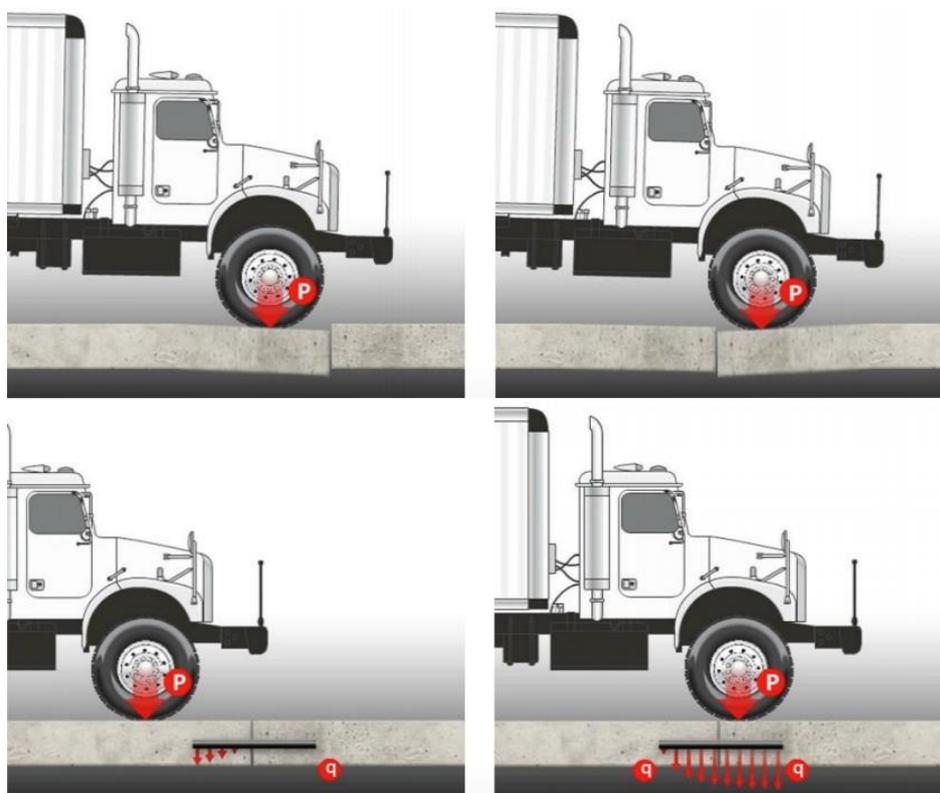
Progresso de abertura de trincas em juntas de pavimentos rígidos
